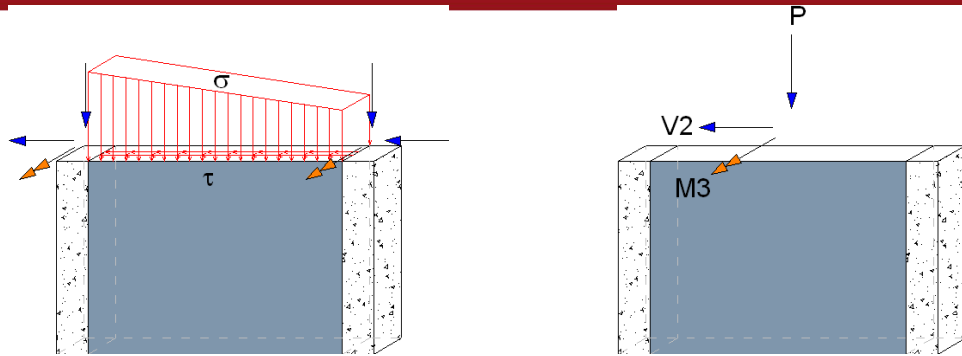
Muro de albañilería confinada modelado con un muro pier formado por elementos de línea y de área.
